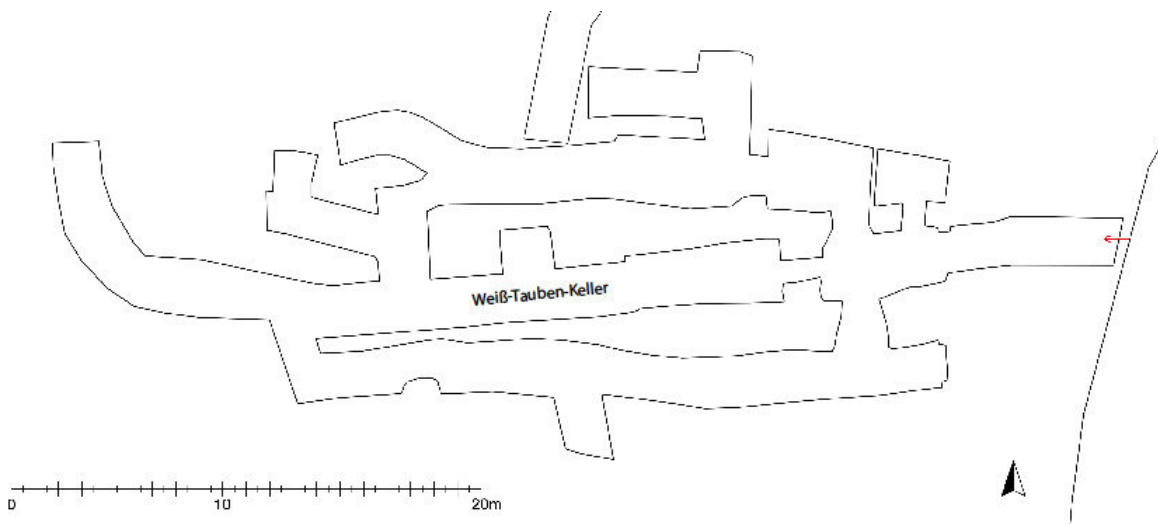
Grundriss Weiß-Tauben-Keller
